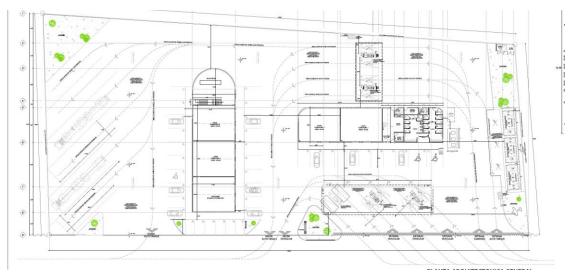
Plano de conjunto de las obras permanentes del proyecto
